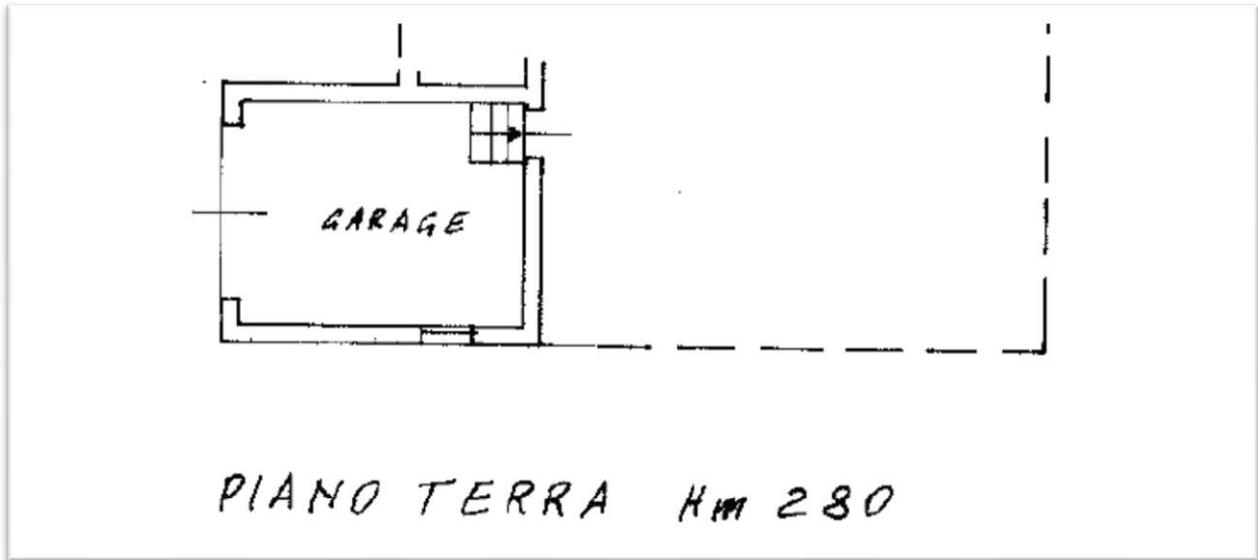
c: Estratto Planimetria catastale Mappale 315, Sub. 5
